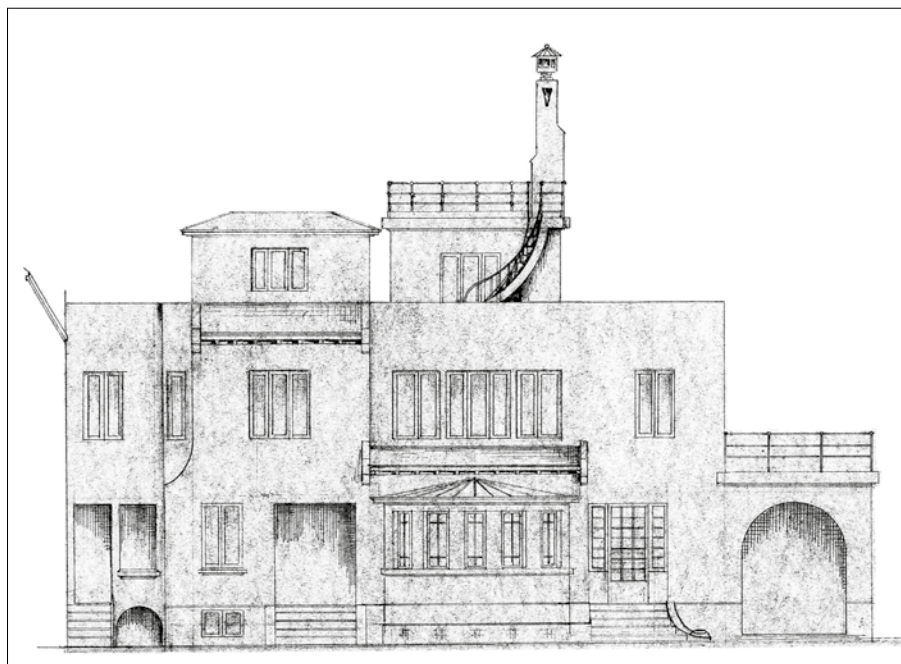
Dibujo plano original de la vivienda. Fuente: Archivo digital de plano facilitado por el Sr. Felipe Silva, arquitecto asesor de Secpla Ñuñoa.
